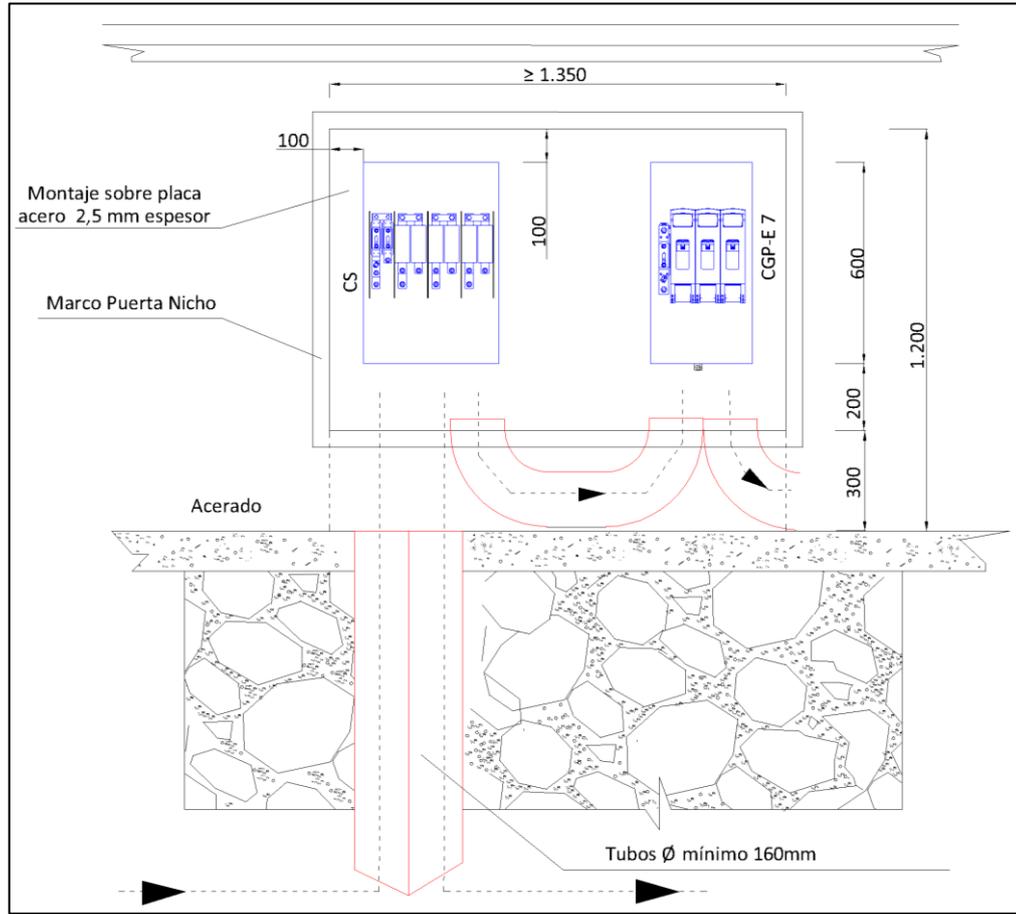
Instalación CGP y CS montaje horizontal. Alzado.
